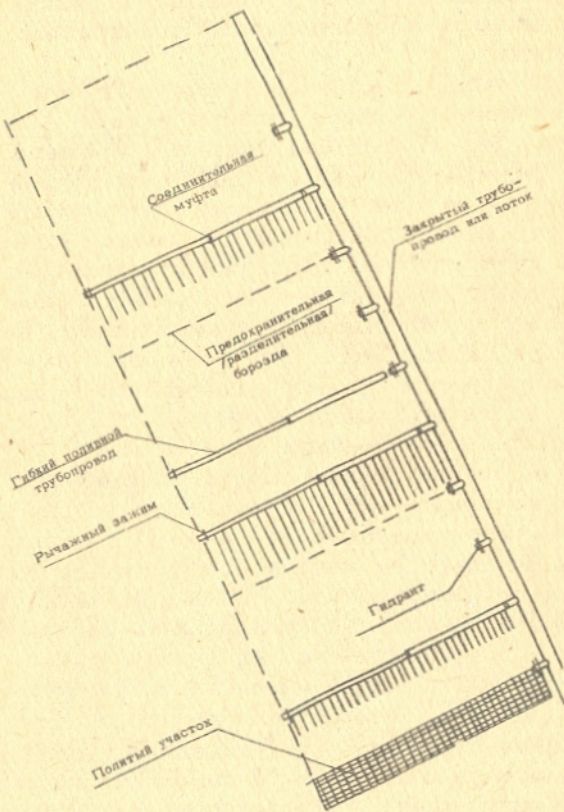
Схема расположения гибких трубопроводов на участке с закрытыми трубопроводами или лотками
